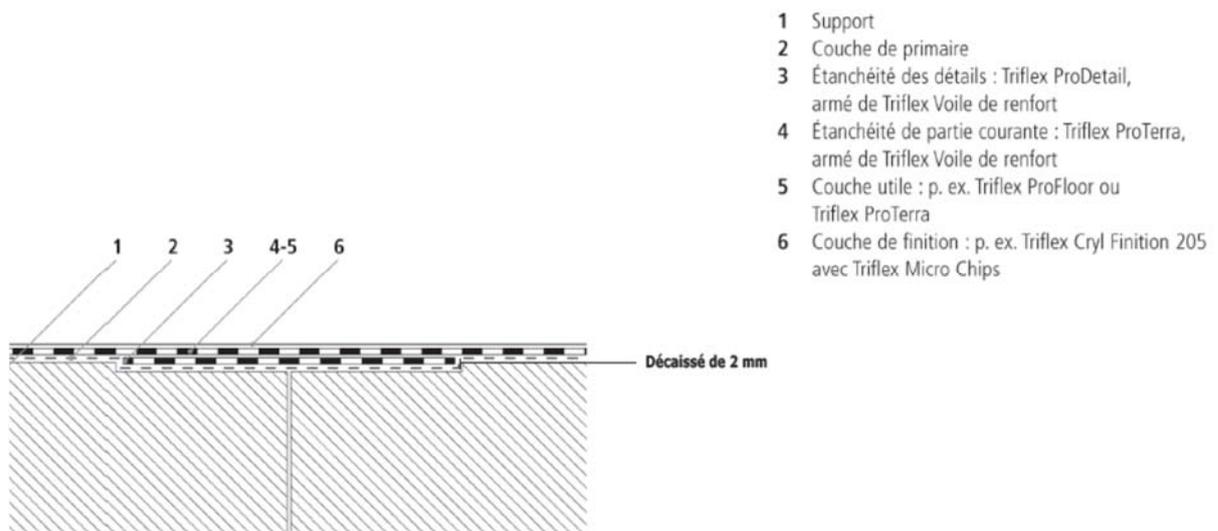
Fissure supérieure ou égale à 1 mm et joint de reprise des toitures-terrasses accessibles aux piétons (solutions Triflex BTS-T et BTS-P)
